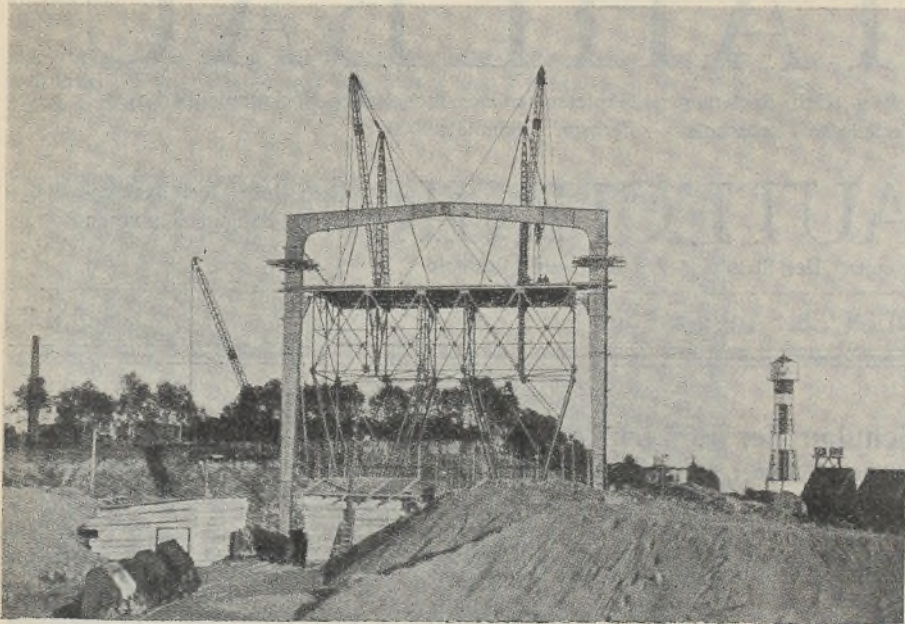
Aufstellen der Binder des Maschinenhauses.
